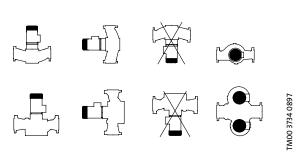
Einbau von Pumpen mit einer Motorleistung bis einschließlich 7,5 kW
